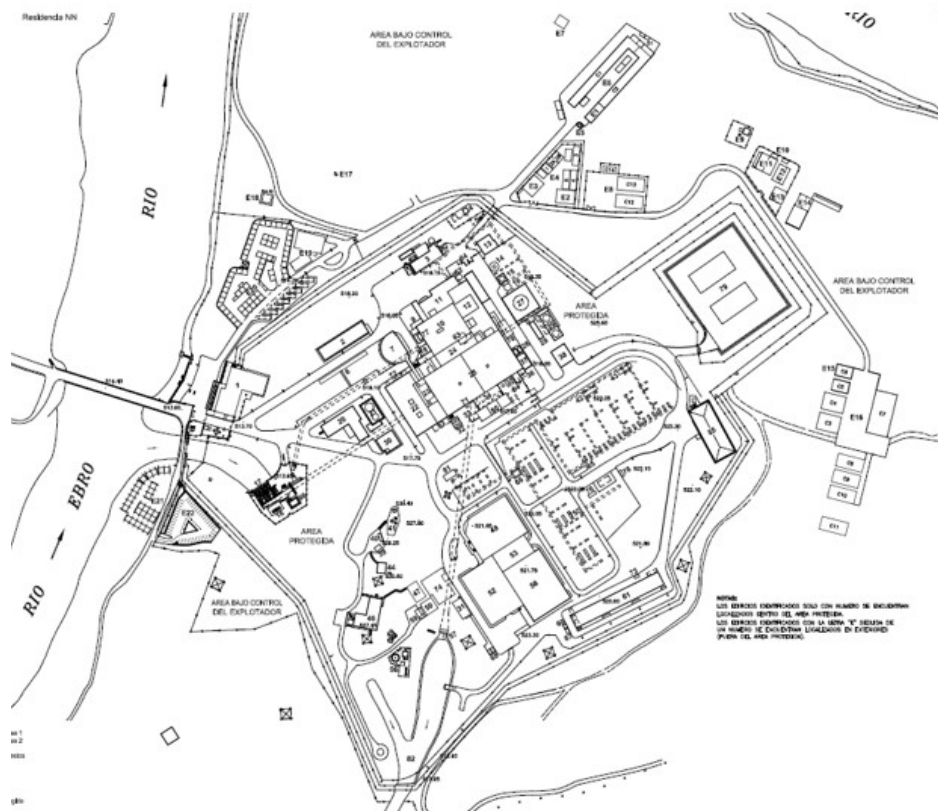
Planta de la C.N. Santa María de Garoña (ATI situado a la derecha de la imagen)
